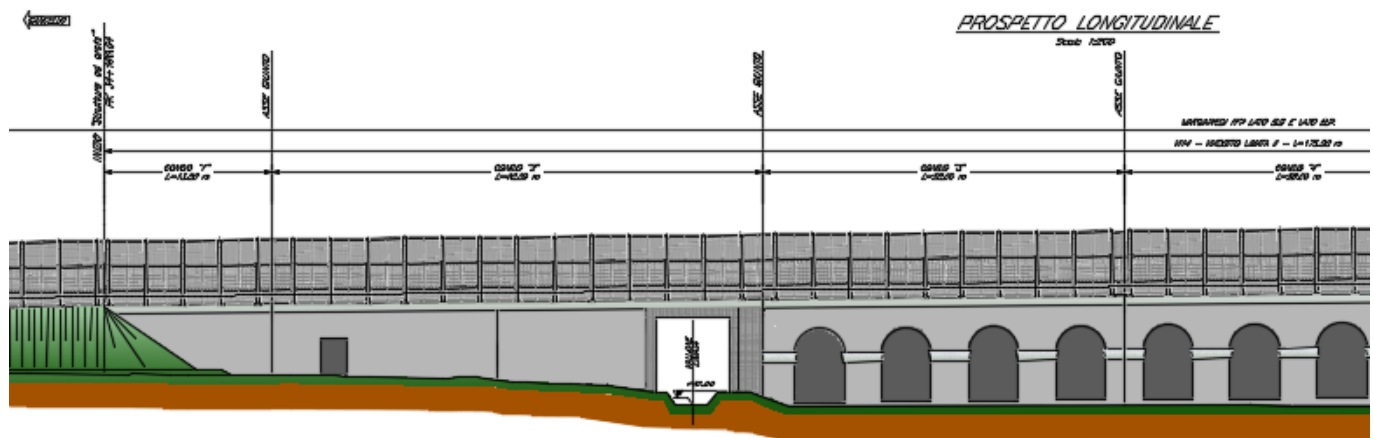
Prospetto del VI14 1 di 2 - "struttura ad archi"
